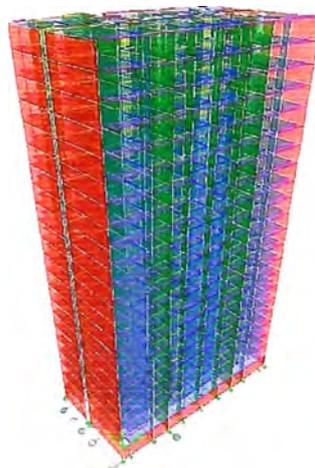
Vista tridimensional del modelo estructural del edificio típico
